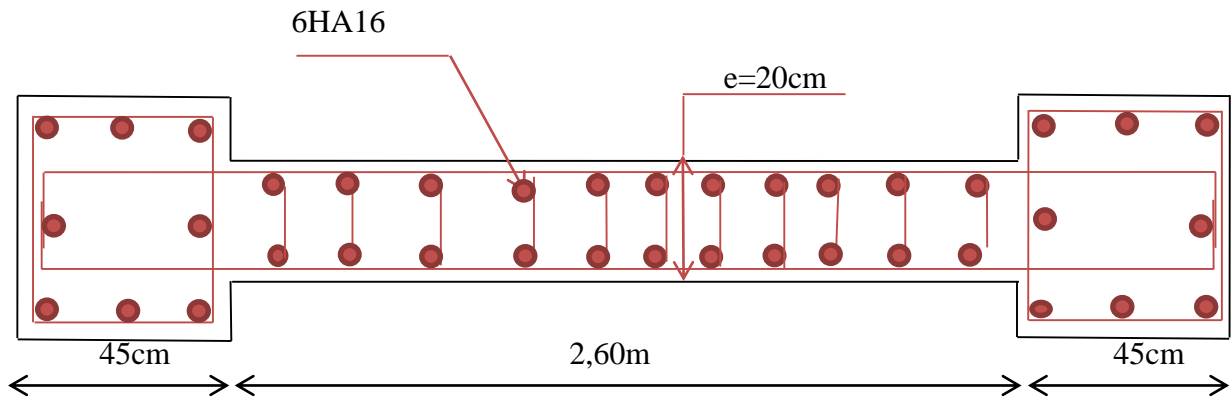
Coupe horizontale de ferrailage des voiles(VL1)ou niveau RDC
